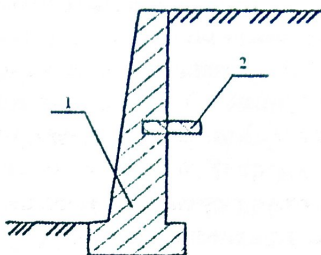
Подпорная стенка с разгрузочной площадкой: 1 – стенка, 2 – разгрузочная площадка
